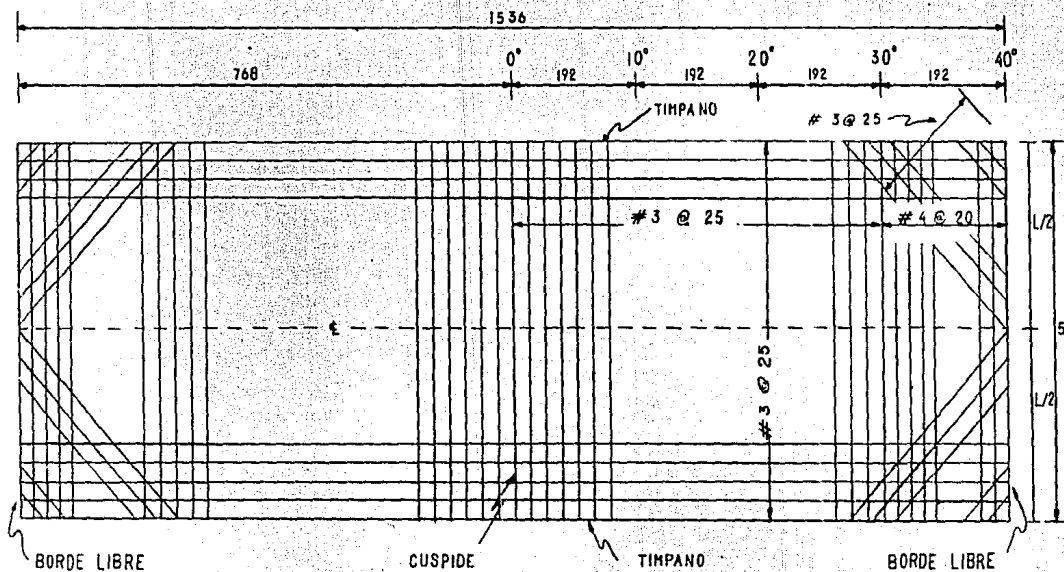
Detalle del armado del cascarón cilíndrico corto de concreto reforzado.
